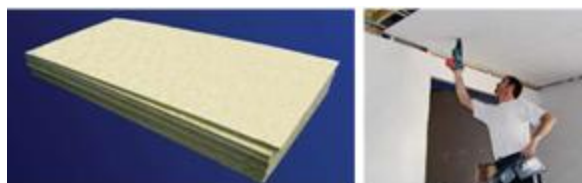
Exemplo e aplicação das placas G70 e G90, Termolan [41]
